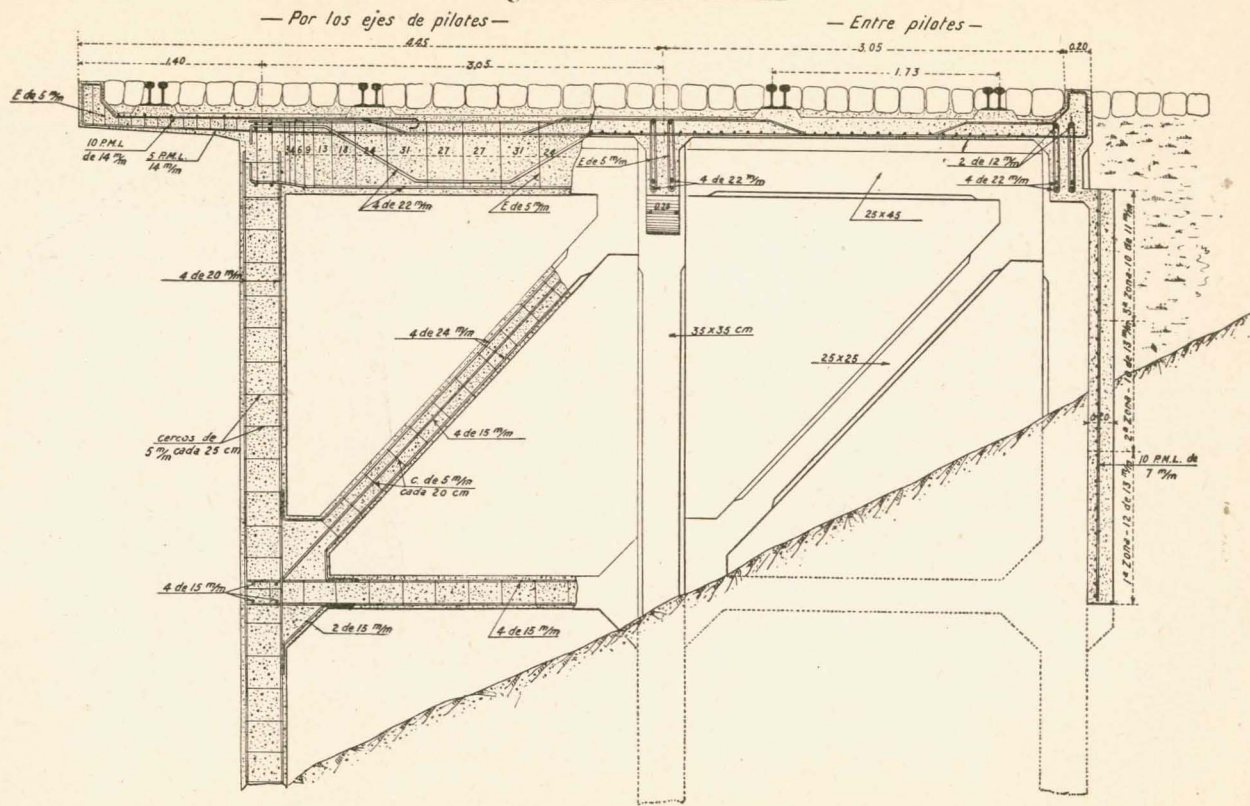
Detalles del muelle de Nueva York, en Sevilla
